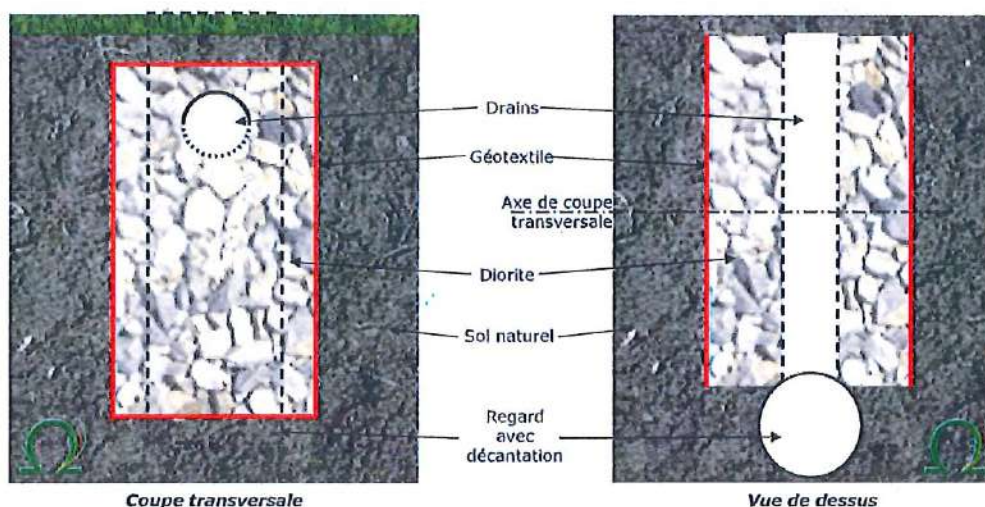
coupe de principe d'une tranchée drainante pour l'infiltration des eaux de toitures
